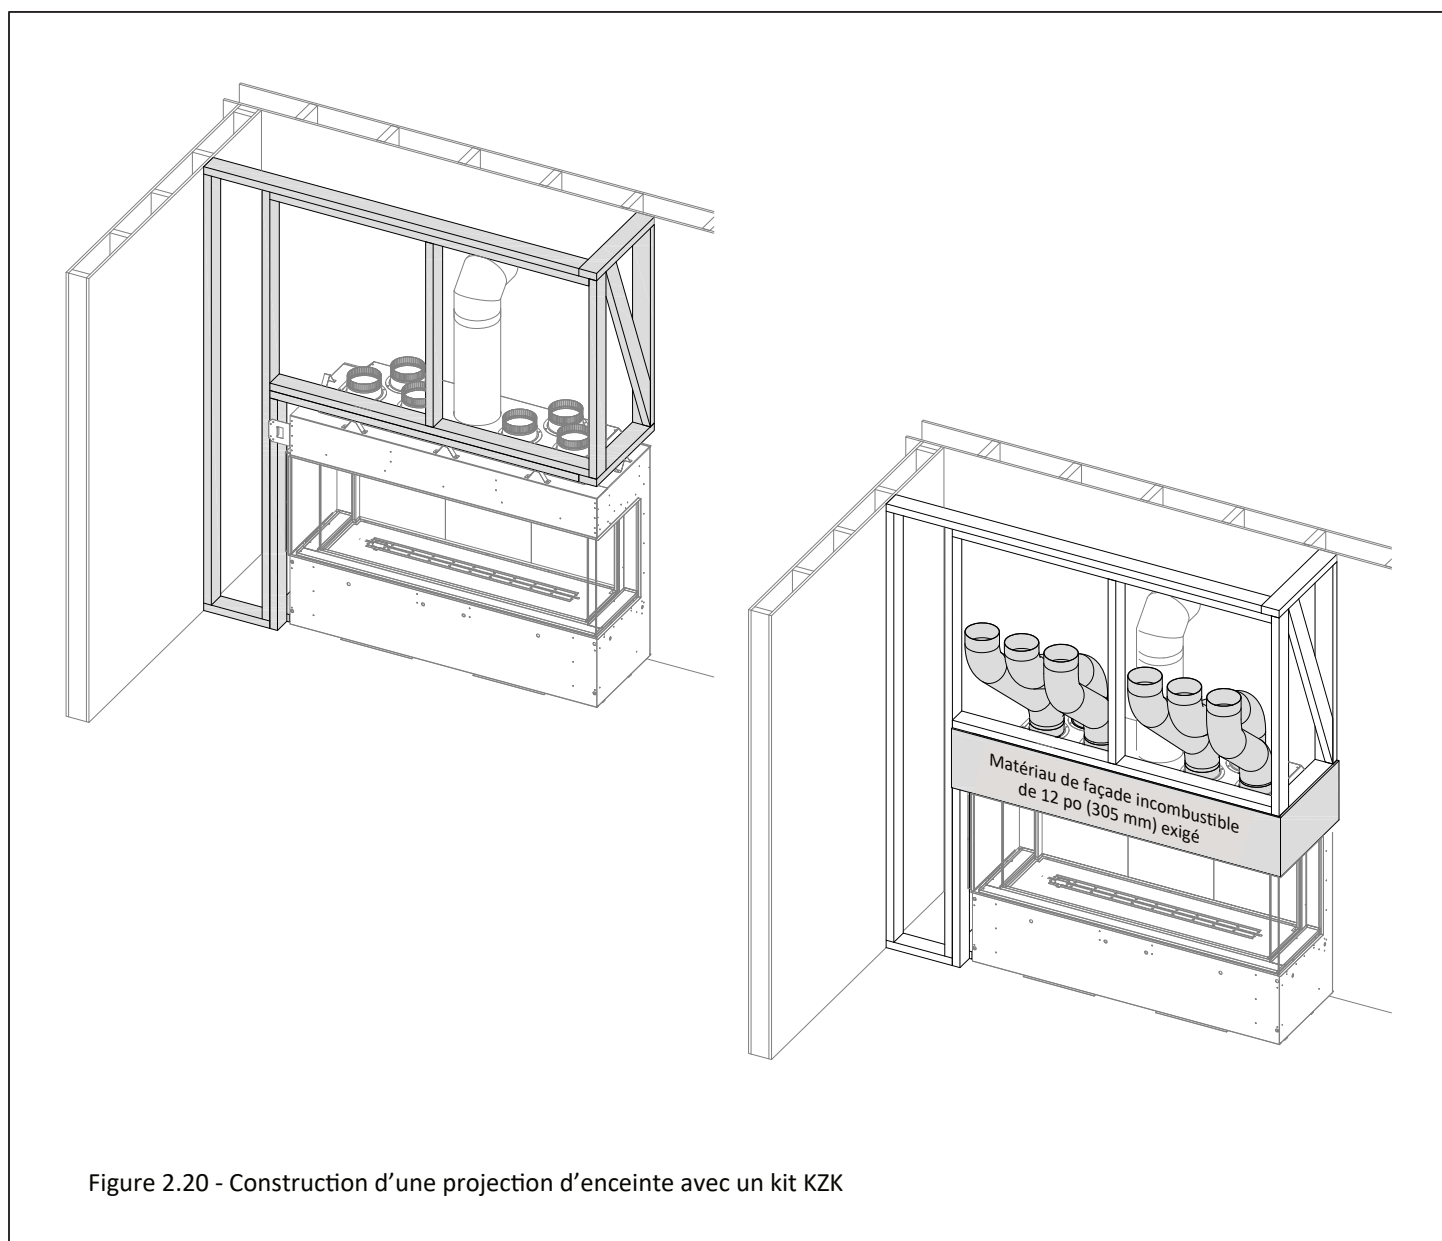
Construction d'une projection d'enceinte avec un kit KZK
